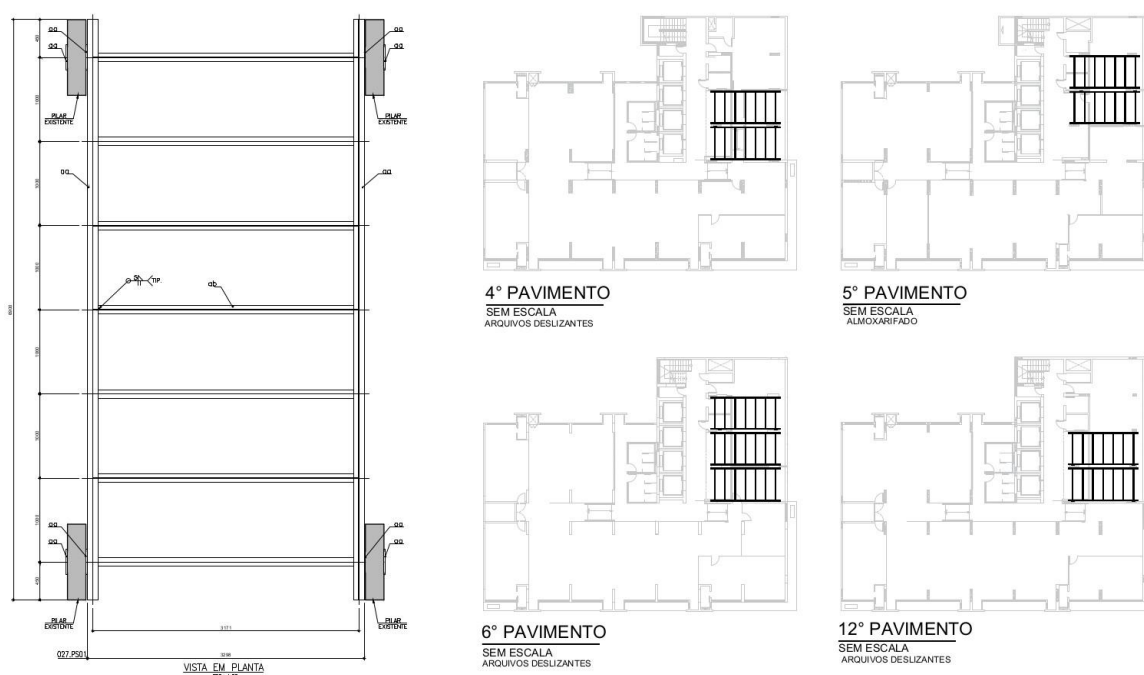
Projeto de estrutura metálica – Reforços para lajes com sobreposo.
